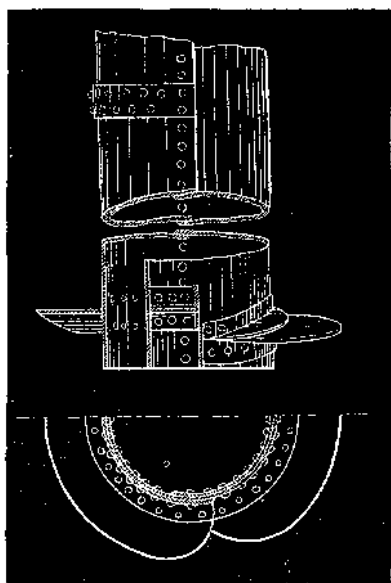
Кольцевой наковенникъ для трубчатыхъ свай.
